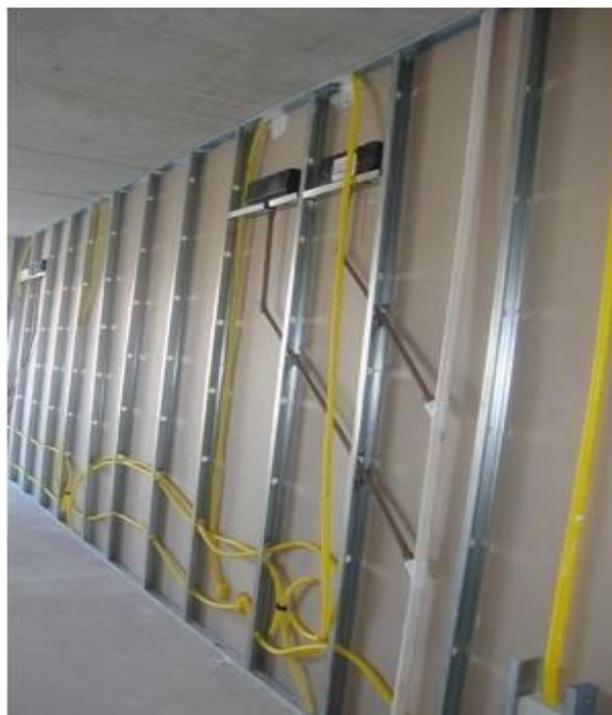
Exemplo do que pode existir dentro de uma simples parede de dry-waal (gesso acartonado), várias instalações elétricas, de TV, drenos para ar condicionado etc.
